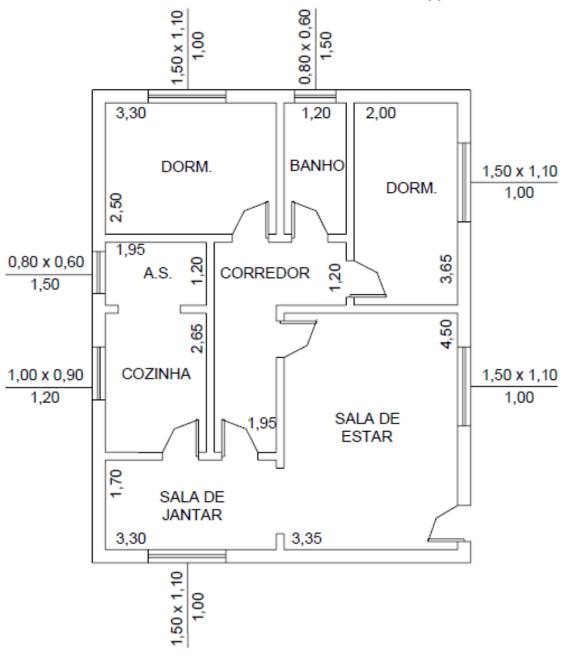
Planta arquitetônica do pavimento tipo [9].
